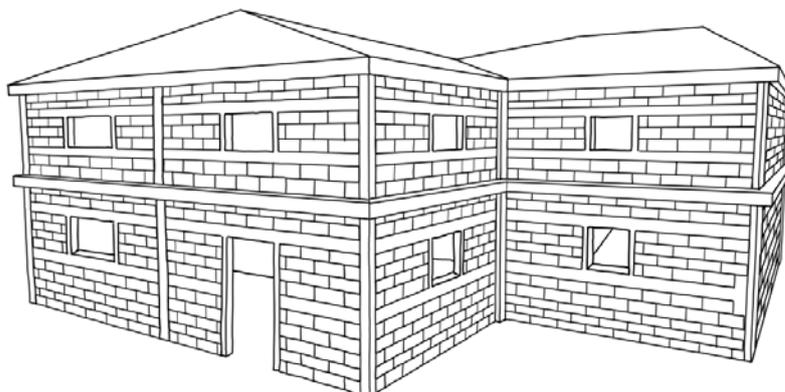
Esquema de mampostería confinada. Fuente: [BIS structures \(ACE\)](#)
